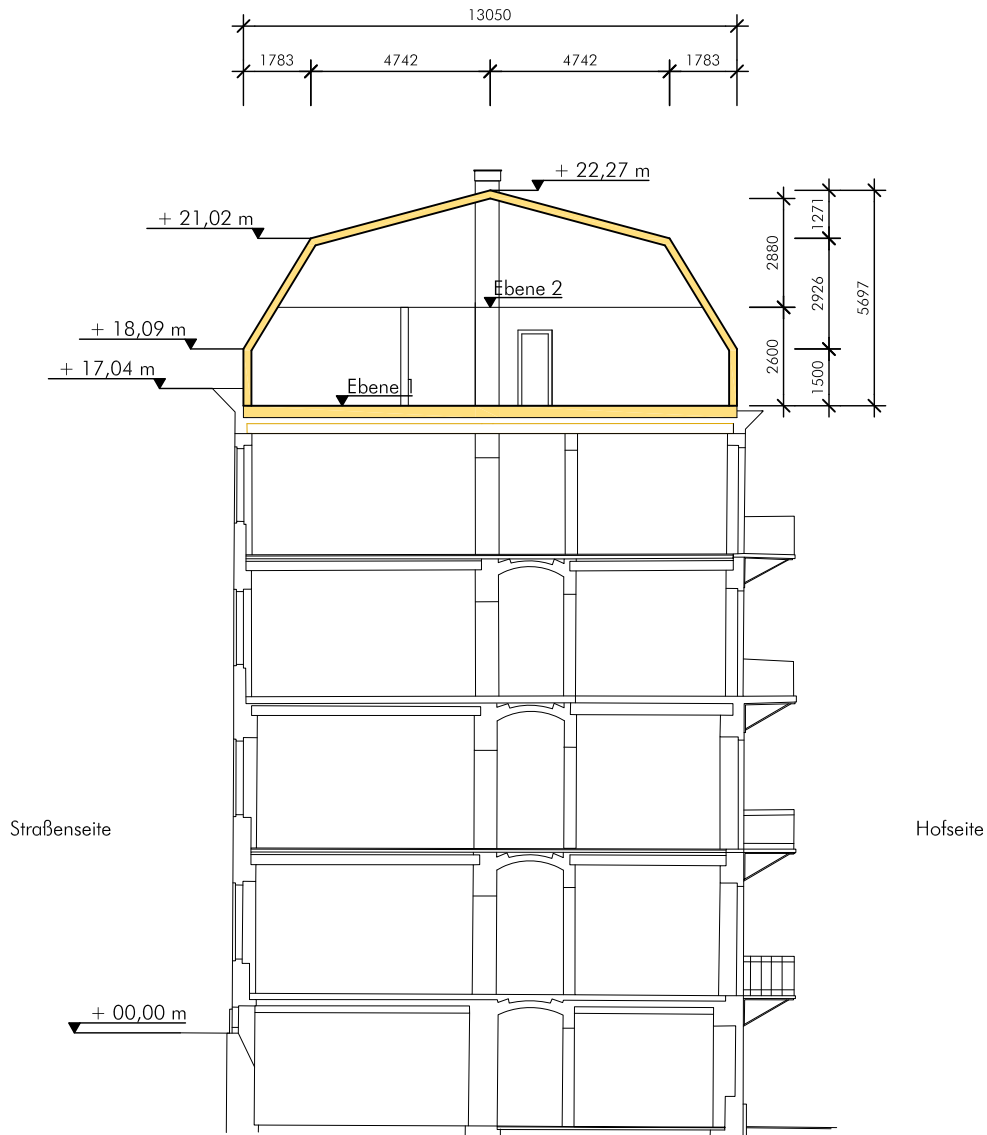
Schnitt Dachgeschoss M 1:200 (Maße in mm)
